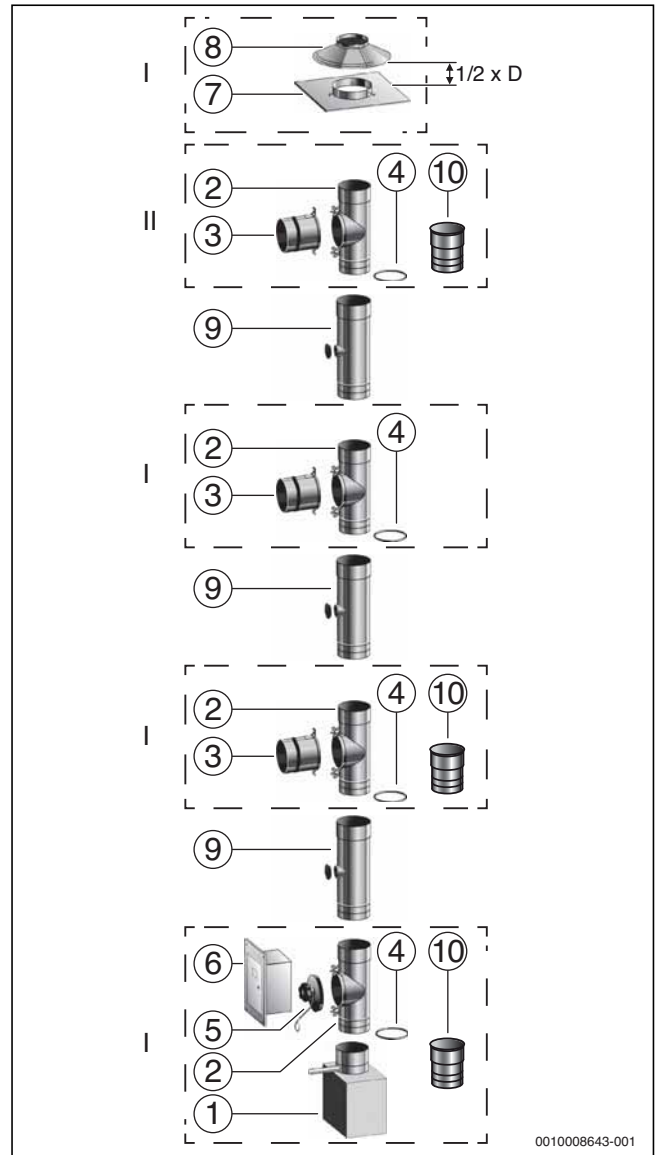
Bauteile des Bausatzes Mehrfachbelegung
